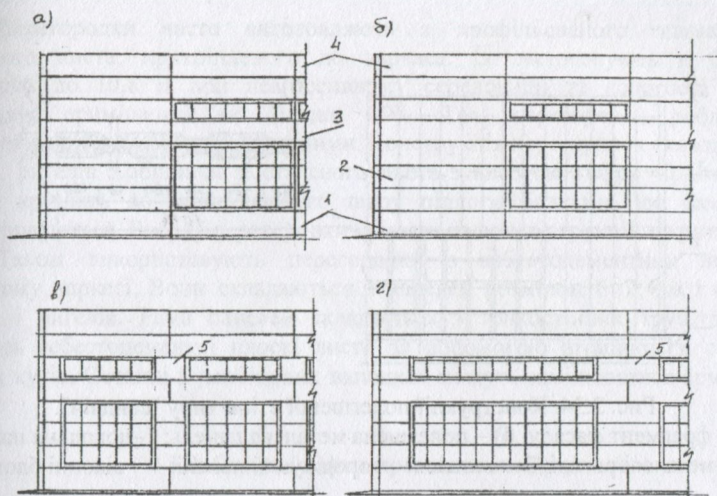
Схеми розрізки стін на крупні панелі виробничих будівель.
